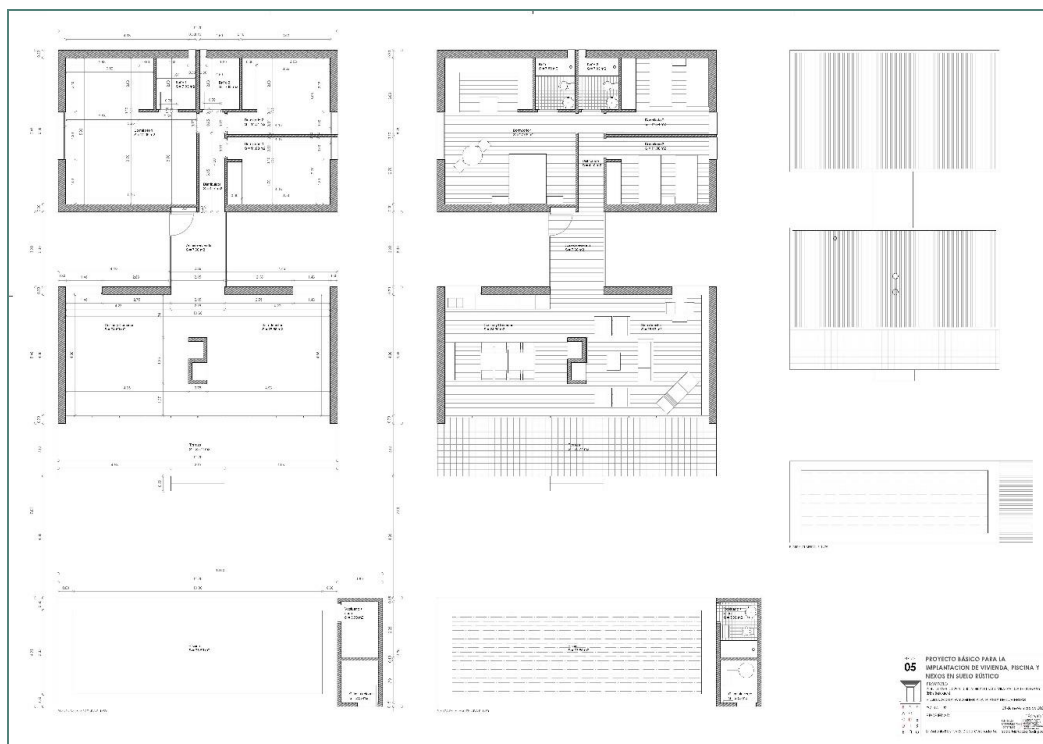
Plànol de planta acotada. Planta de cobertes. Extret del projecte bàsic.
